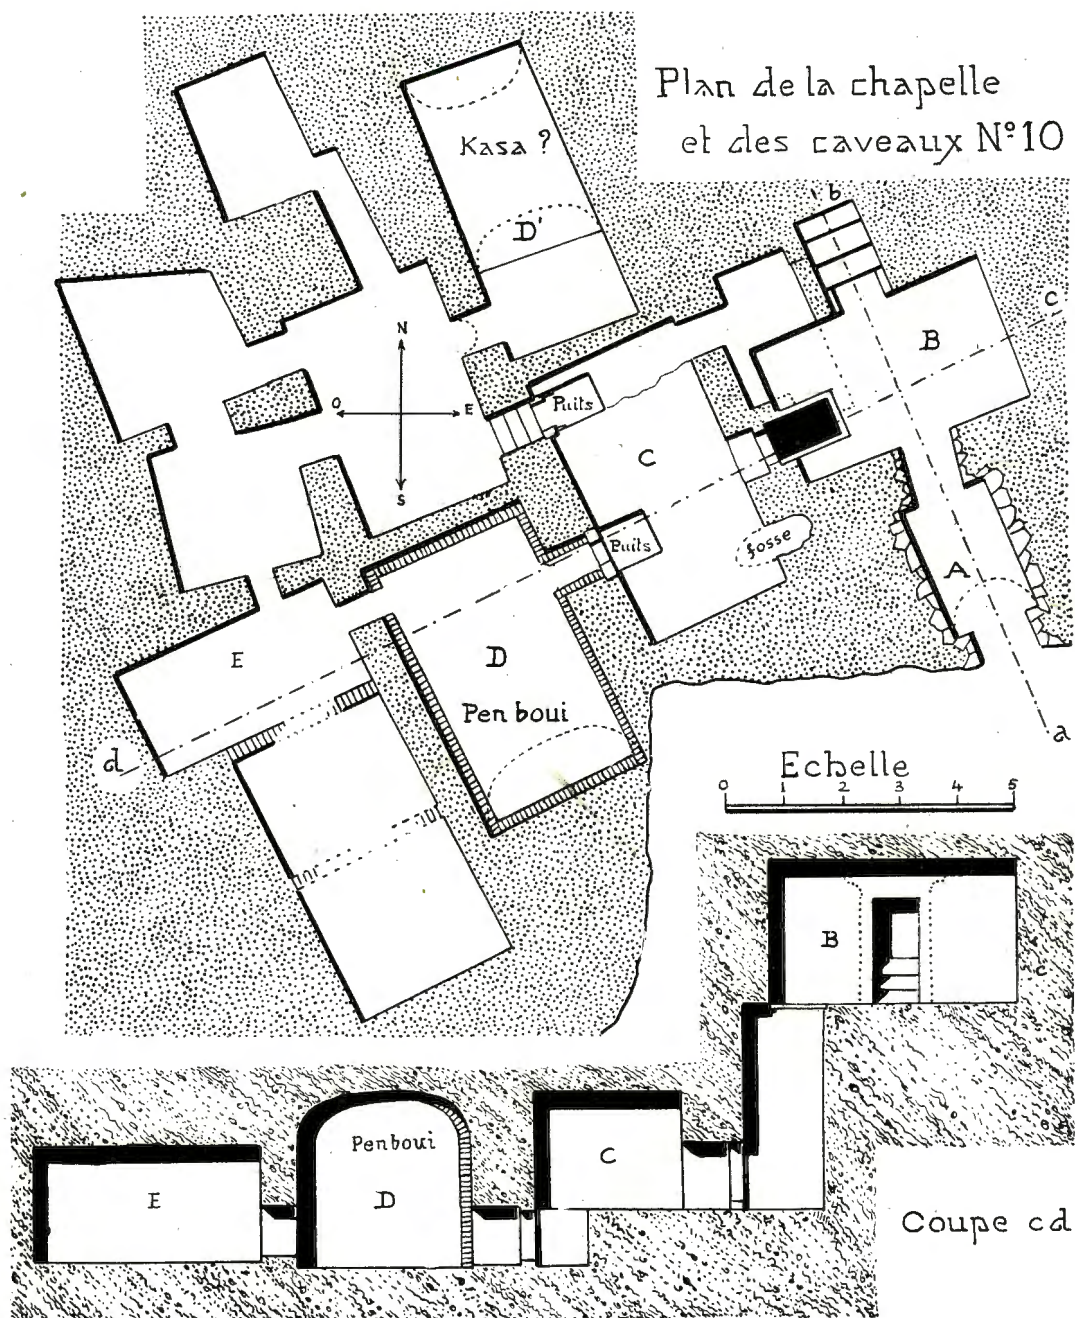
Plan et coupe de l'hypogée de la tombe n° 10.
